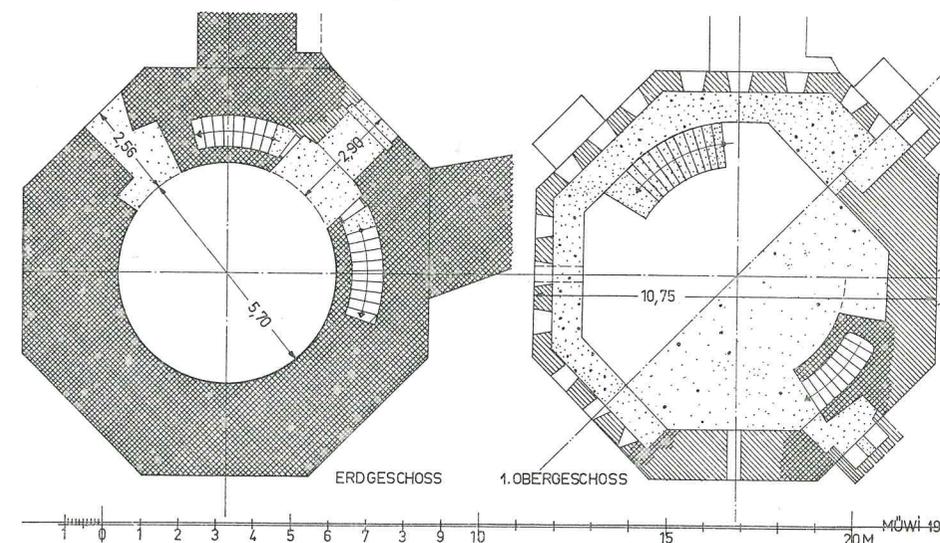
Grundrisse des südwestlichen Eckturmes des Kastells von Sığacık, Maßstab 1 : 200. (Der Grundriß des Obergeschosses ist diagonal geteilt – rechts das untere, links das obere Plattformgeschoß)
